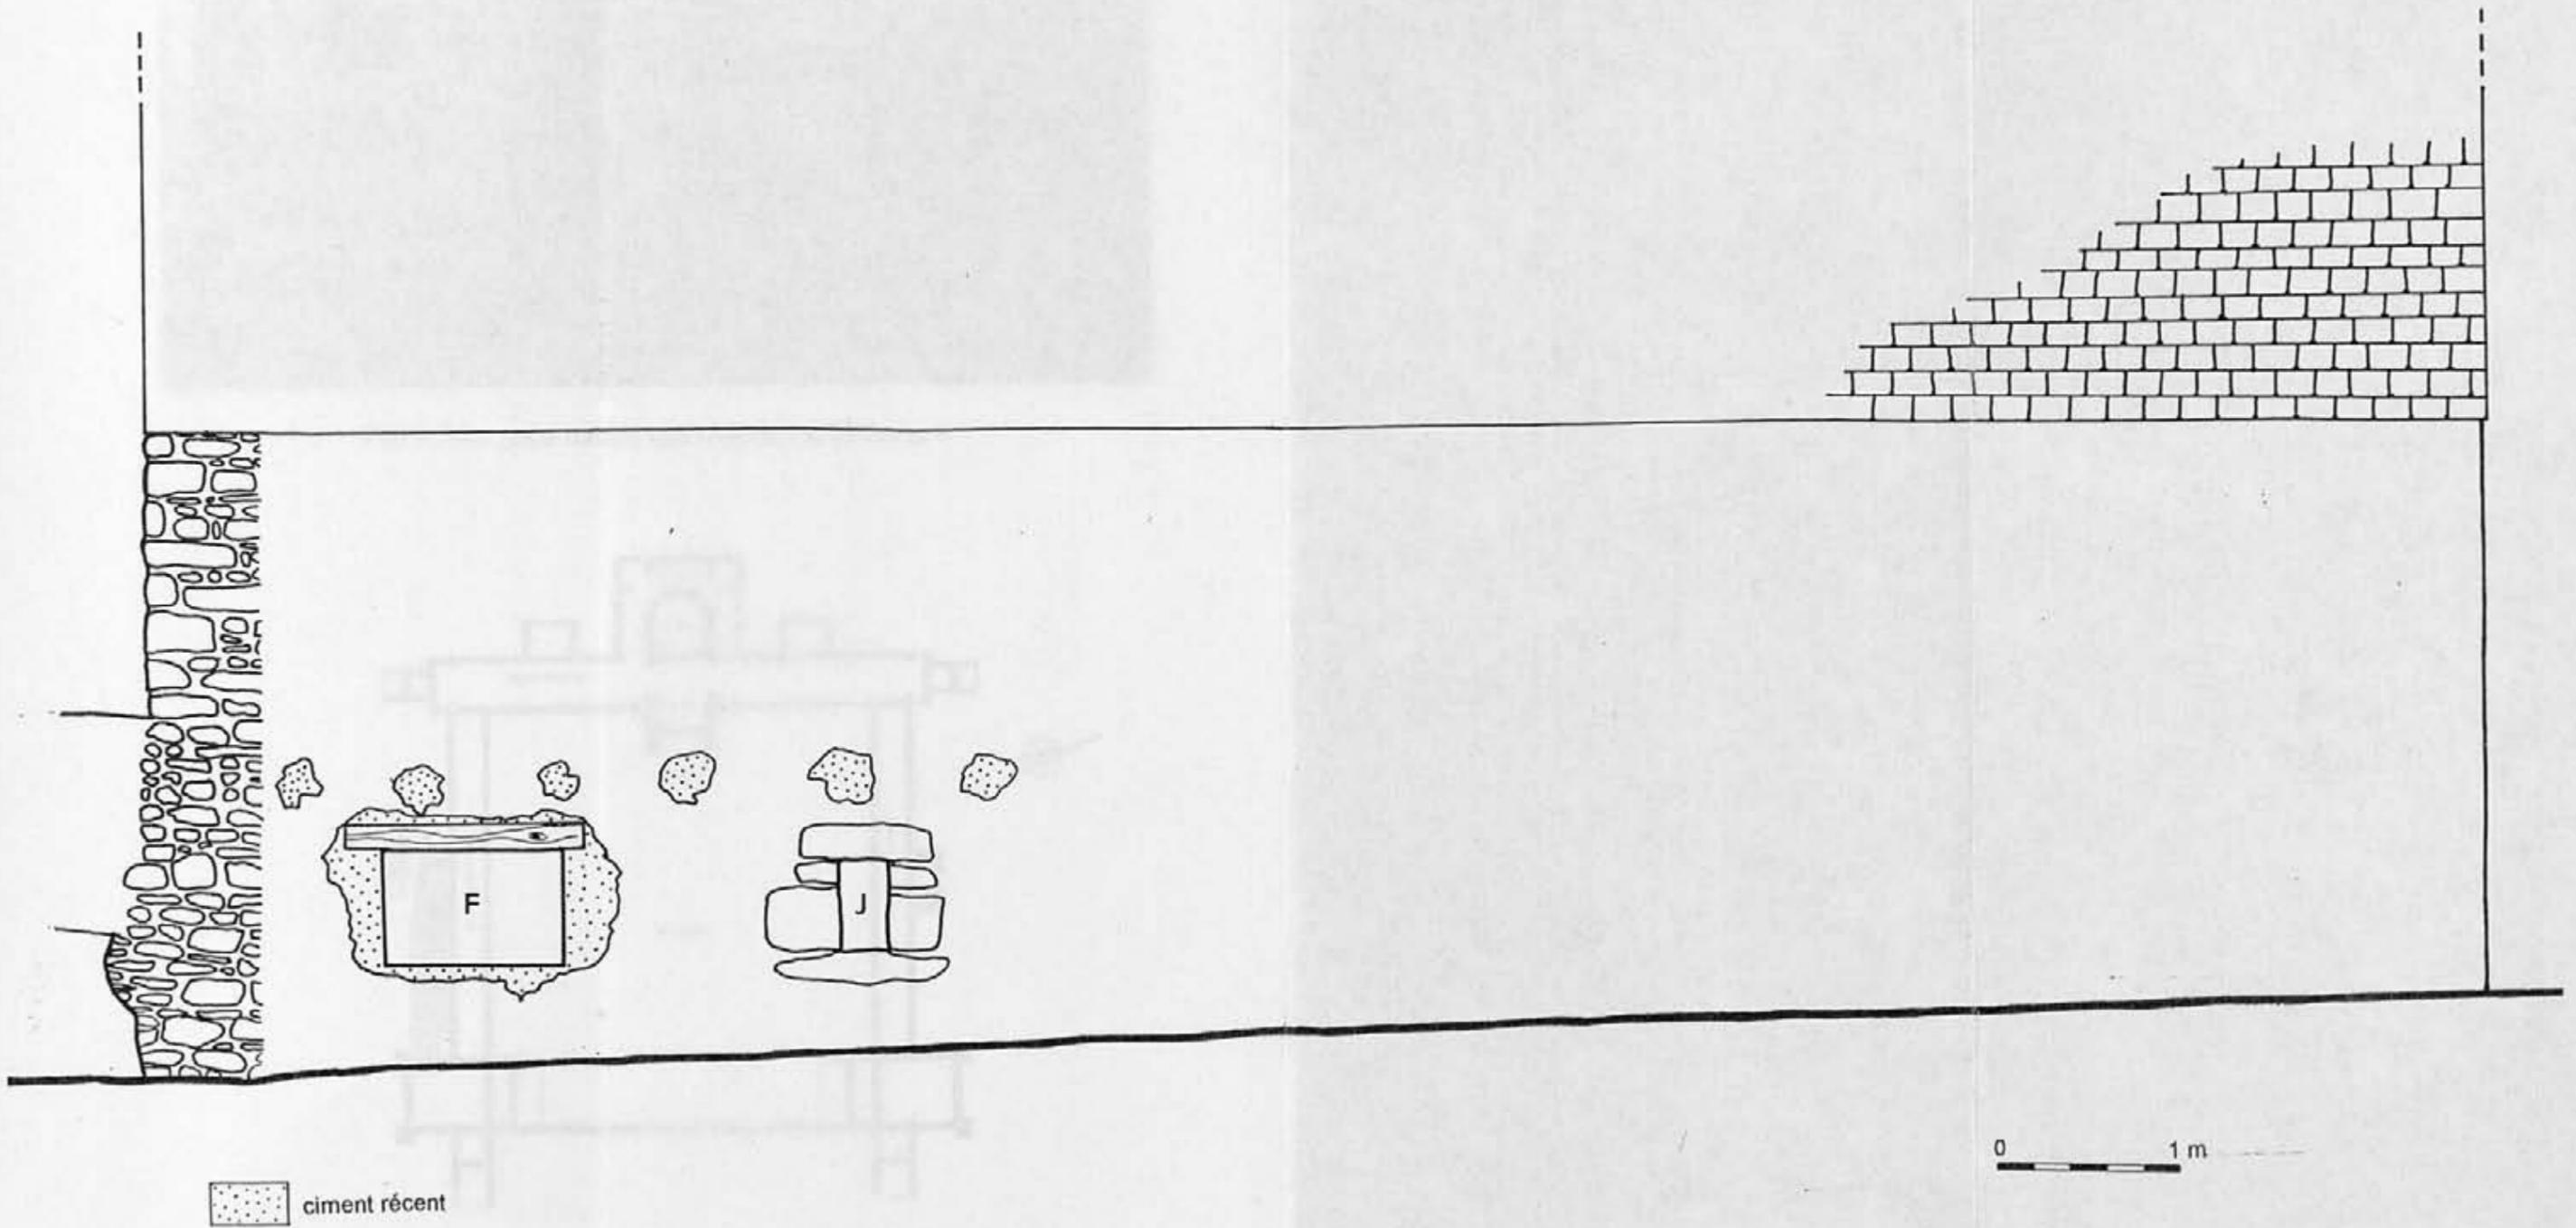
Relevé de la façade arrière (mur 4) - Ferme du Haut-Bécherel (22)
